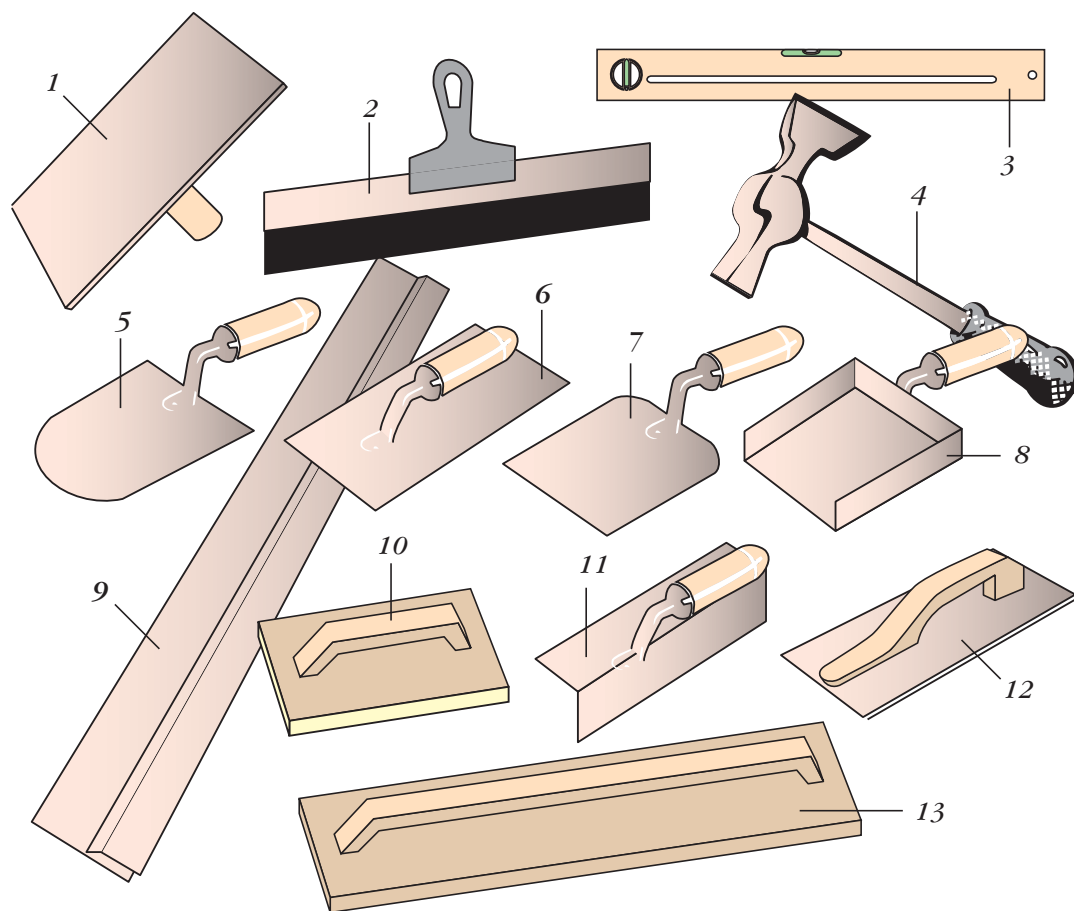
Инструменты для штукатурных работ: 1 — сокол; 2 — шпатель; 3 — уровень; 4 — топорик; 5 — штукатурный мастерок; 6 — гладилка; 7 — штукатурная лопатка; 8 — совок; 9 — правило; 10 — терка; 11 — выравниватель угловой; 12 — штукатурная кельма (малка); 13 — полутерок
